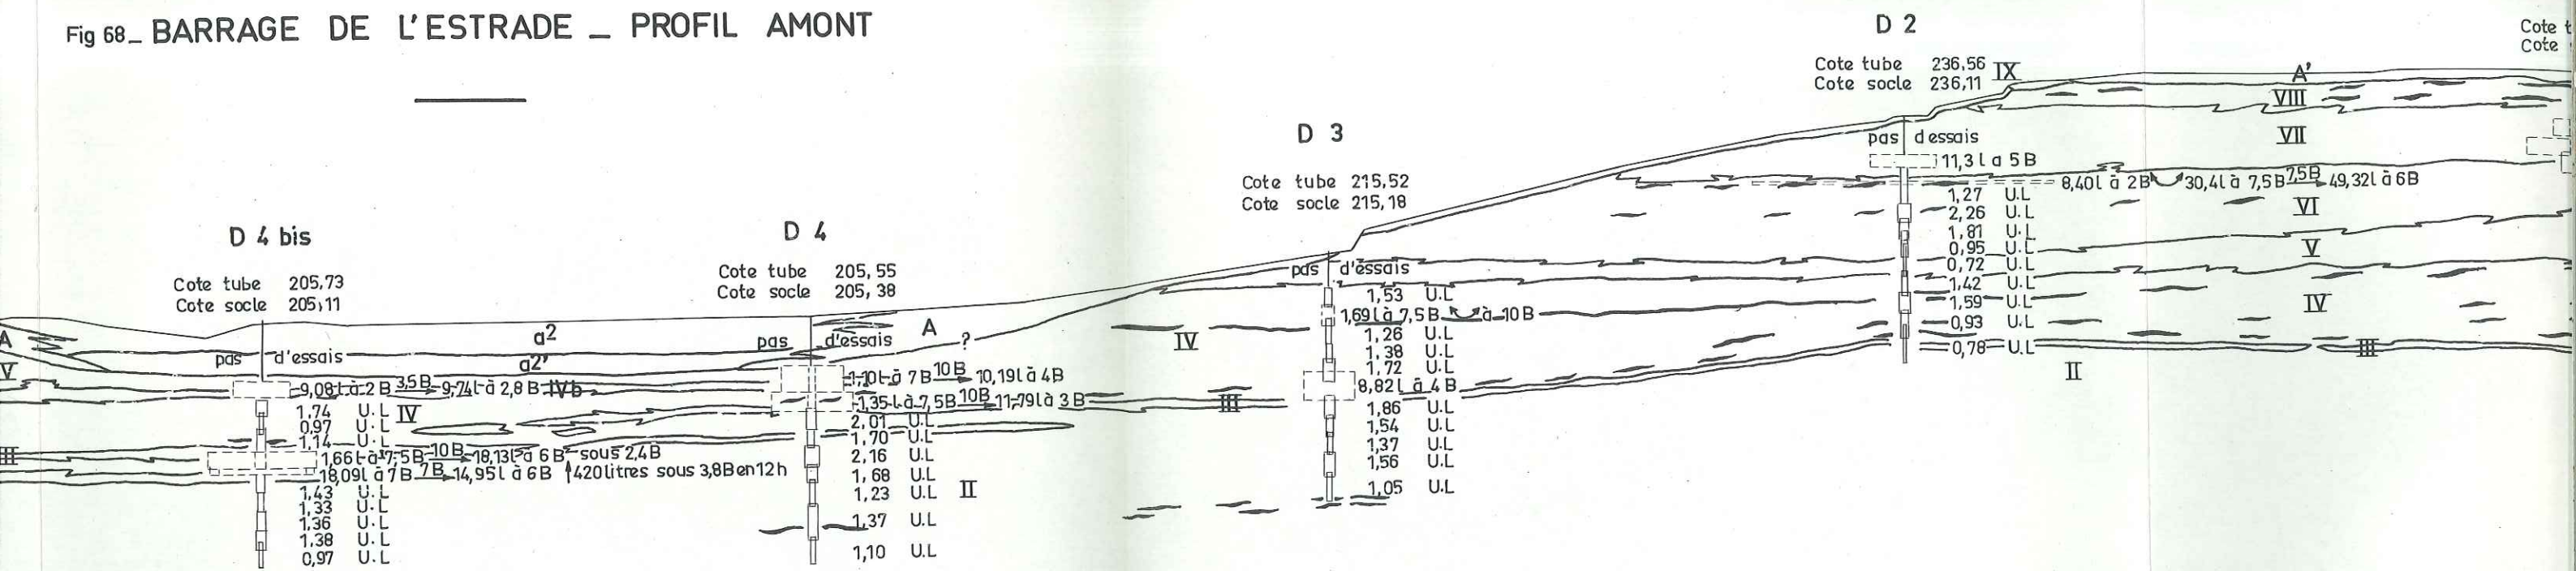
\_ BARRAGE DE L'ESTRADE \_ PROFIL AMONT
